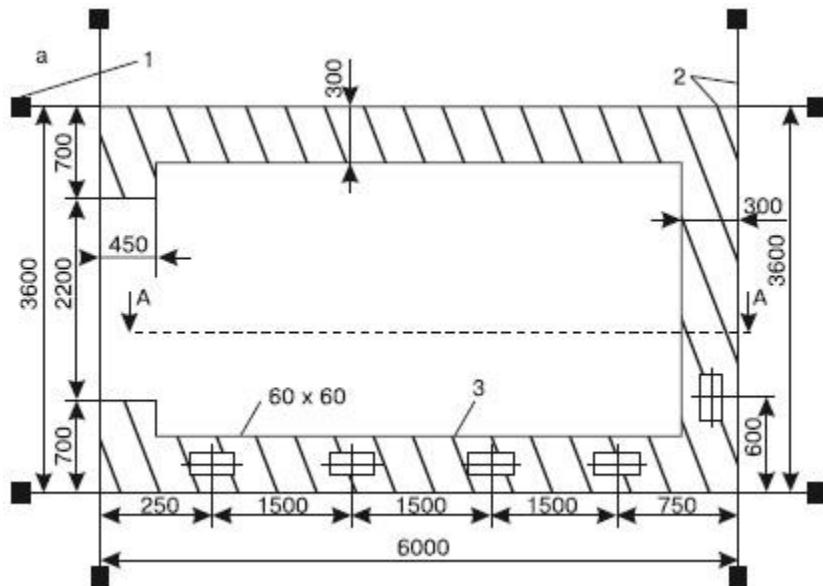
План фундамента под гараж: 1 – деревянные колышки; 2 – разбивочный шнур; 3 – банкет
